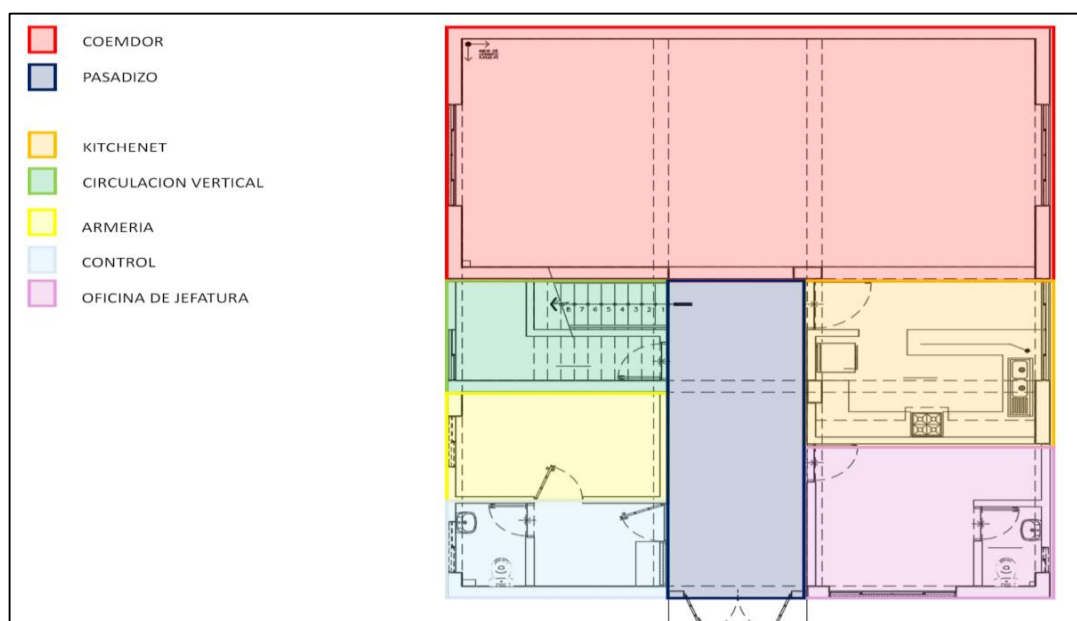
Planta 1er piso del pabellón Seguridad Interna
